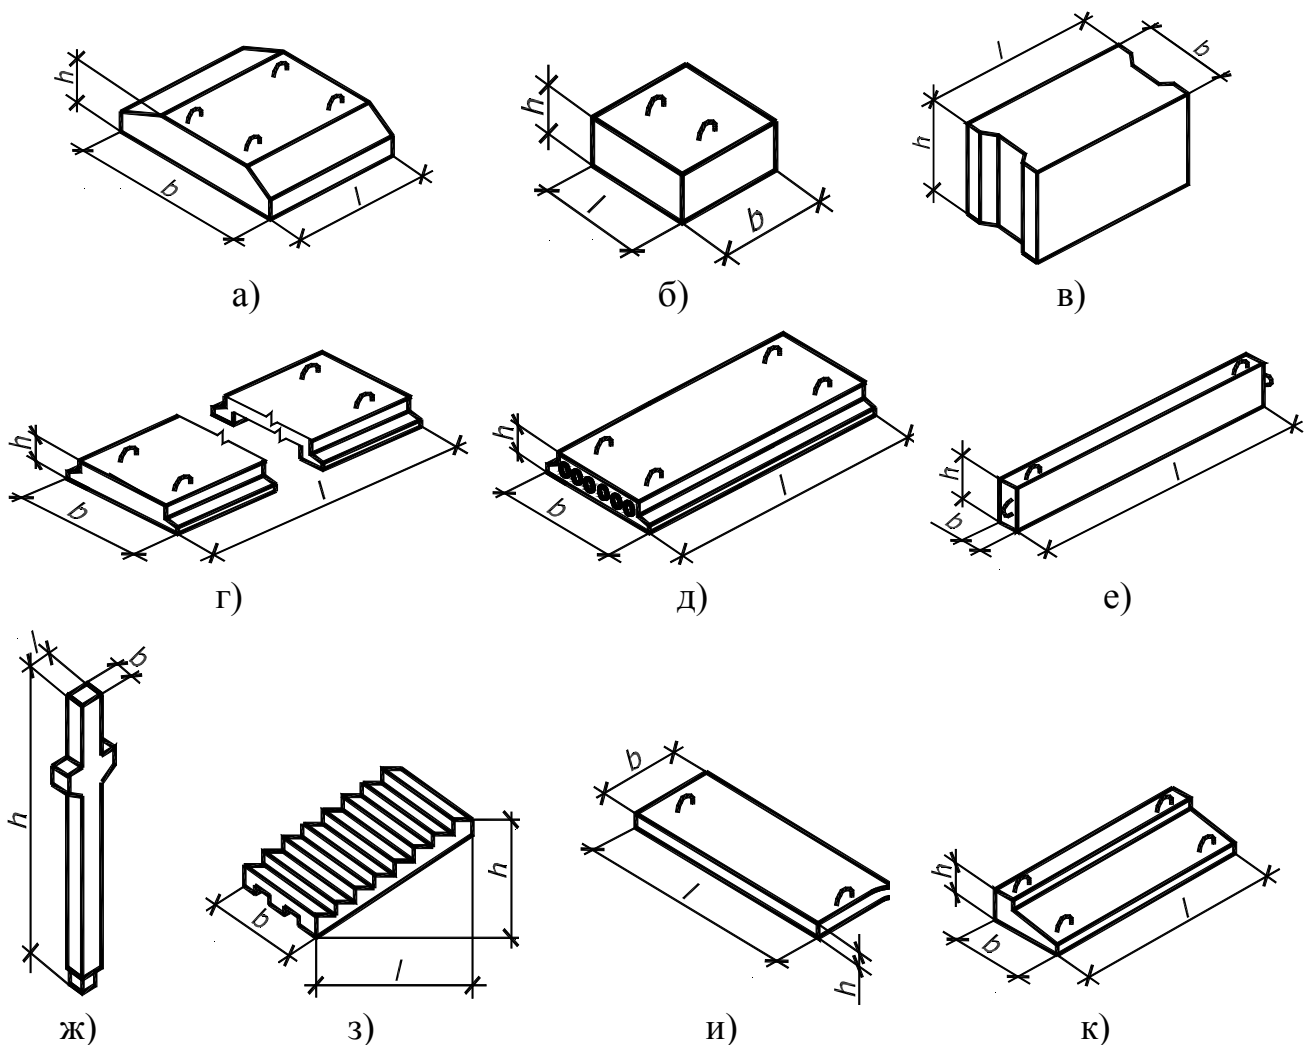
Типовые железобетонные изделия: а) фундаментный блок; б), в) стеновые блоки подвала; г) настил перекрытия; д) плита перекрытия с круглыми отверстиями; е) ригель или прогон; ж) колонна; з) лестничный марш; и) мозаичная проступь; к) балконная плита
